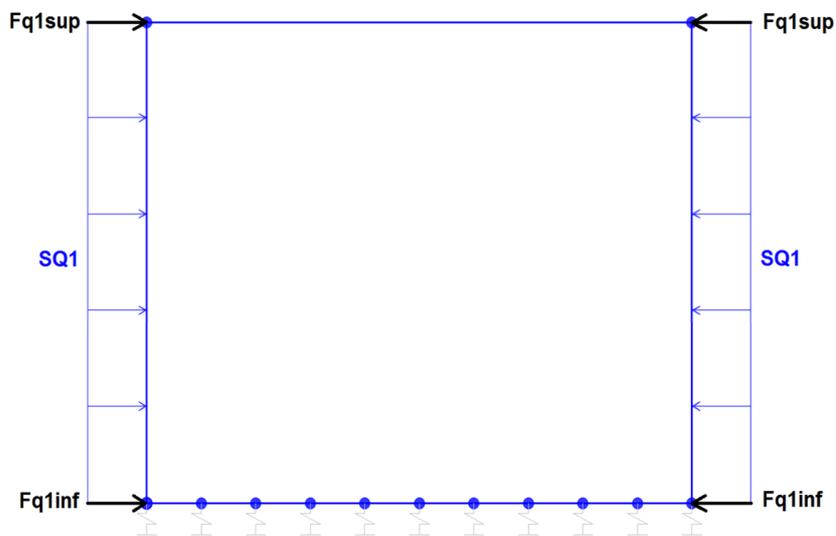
Condizione di carico SPACCSX e SPACCDX da SAP2000
